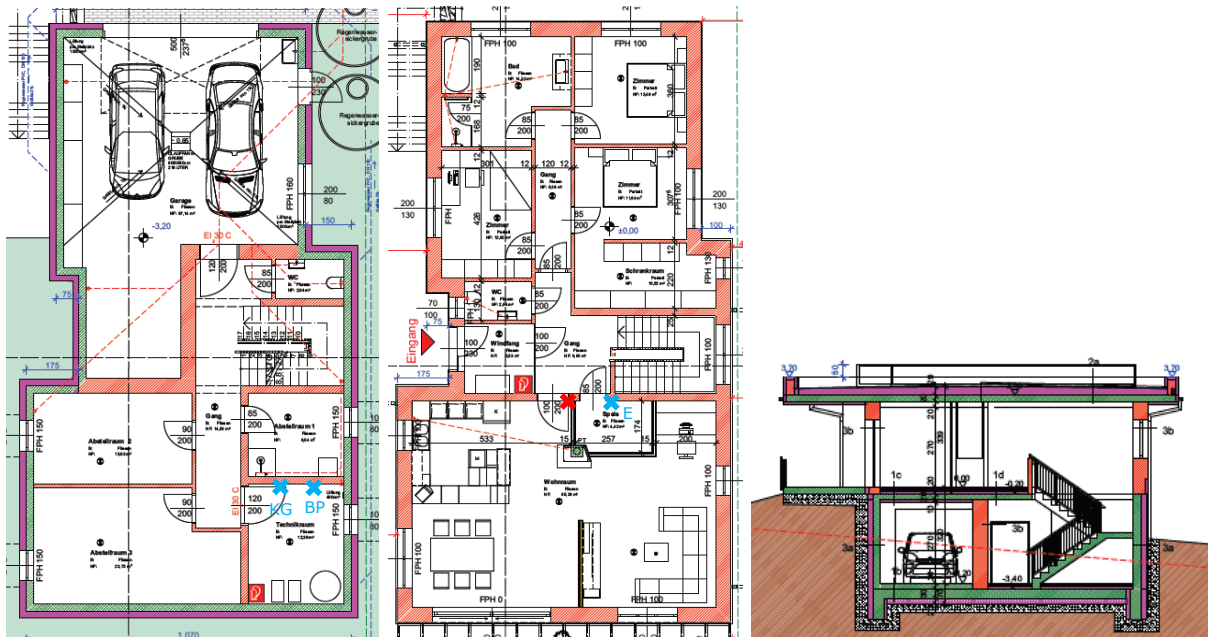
Grundriss UG (links), Grundriss EG (Mitte) und Schnitt (rechts) des Solarhauses Doppelhofer inkl. Position der Raum- (rot) und Betontemperaturfühler (blau, BP = Bodenplatte, KG = Decke KG, EG = Decke EG) (Quelle: Einreichplan)
